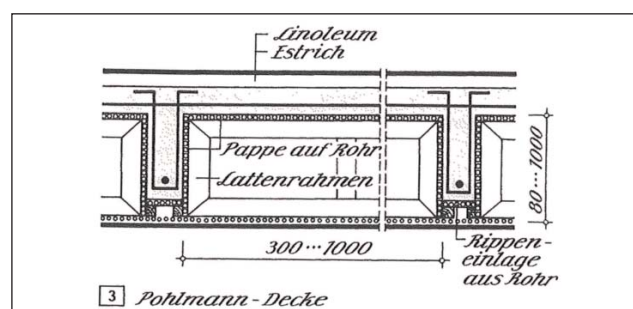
Pohlmanndecke mit Rippen und Spiegel aus Beton nach [6]
